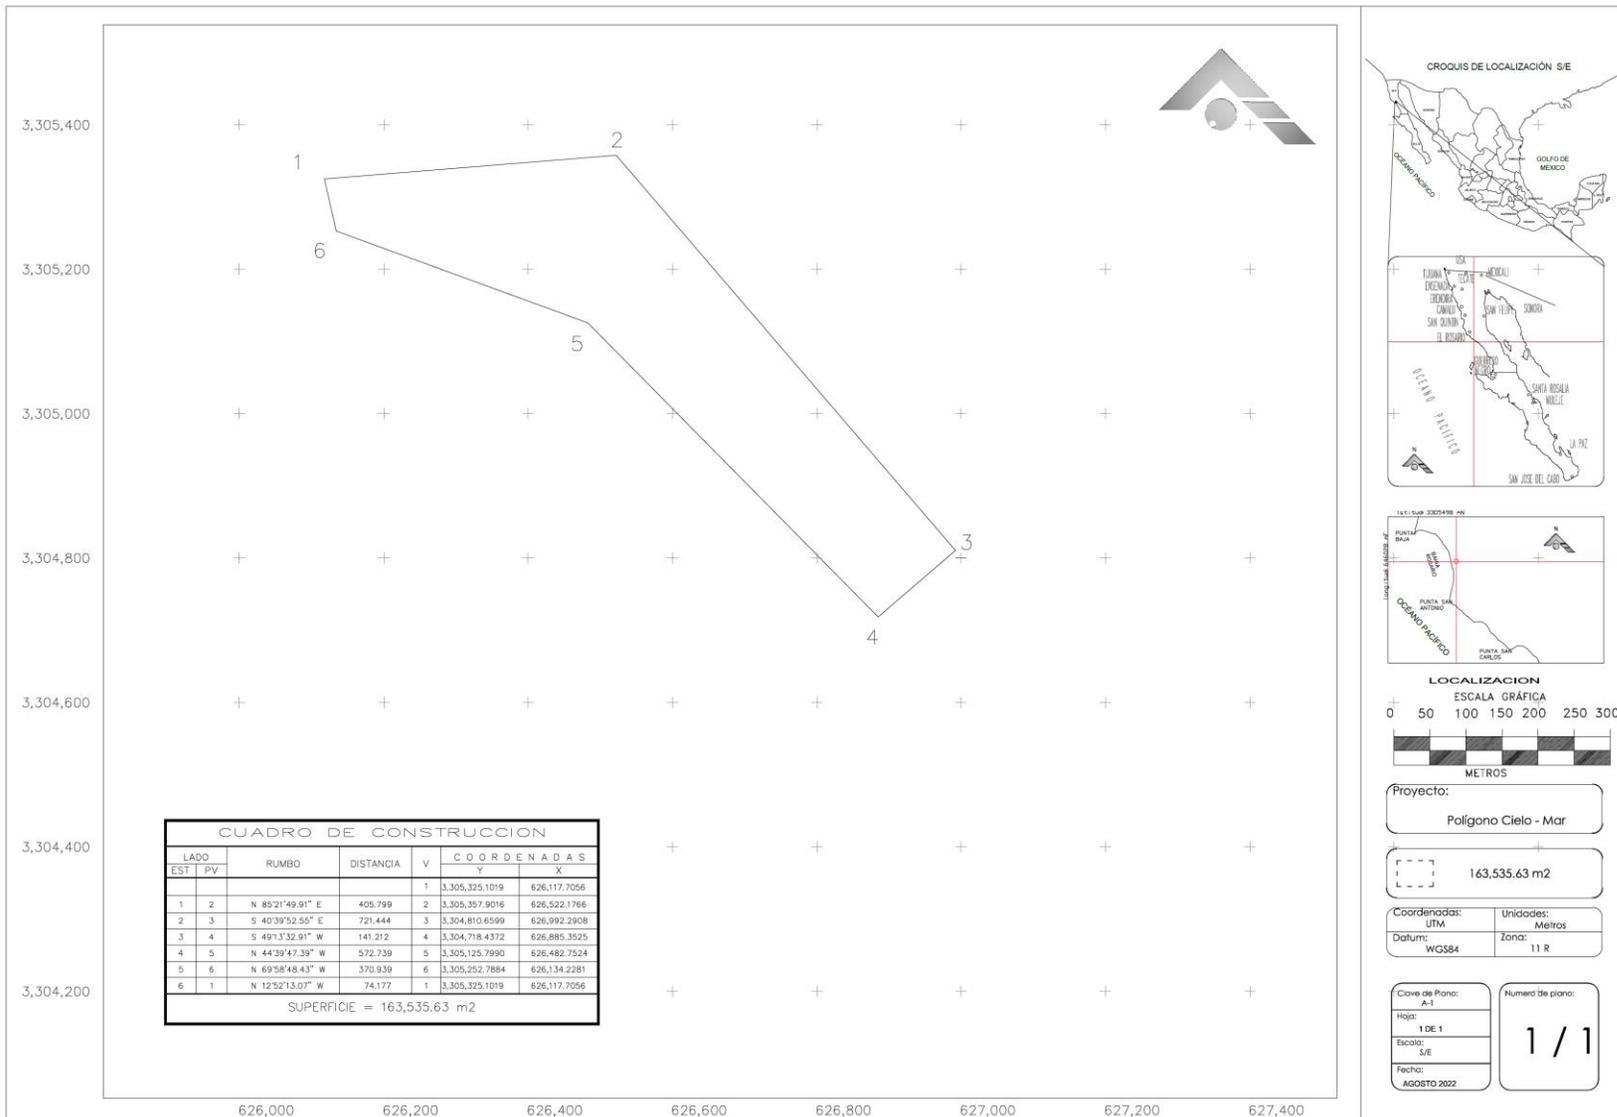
Plano que muestra el polígono del predio seleccionado para el proyecto. Área solicitada para CUSTF: 16-35-35.63 Ha (Coordenadas en m, sistema UTM, 11R, Datum WGS84). Ver plano anexo.
